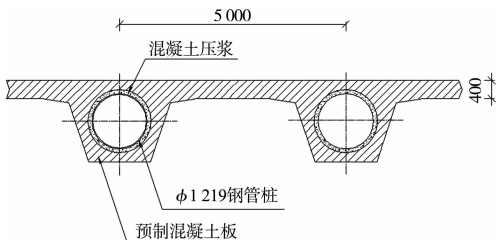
预制混凝土板与钢管桩连接大样 (单位: mm)
